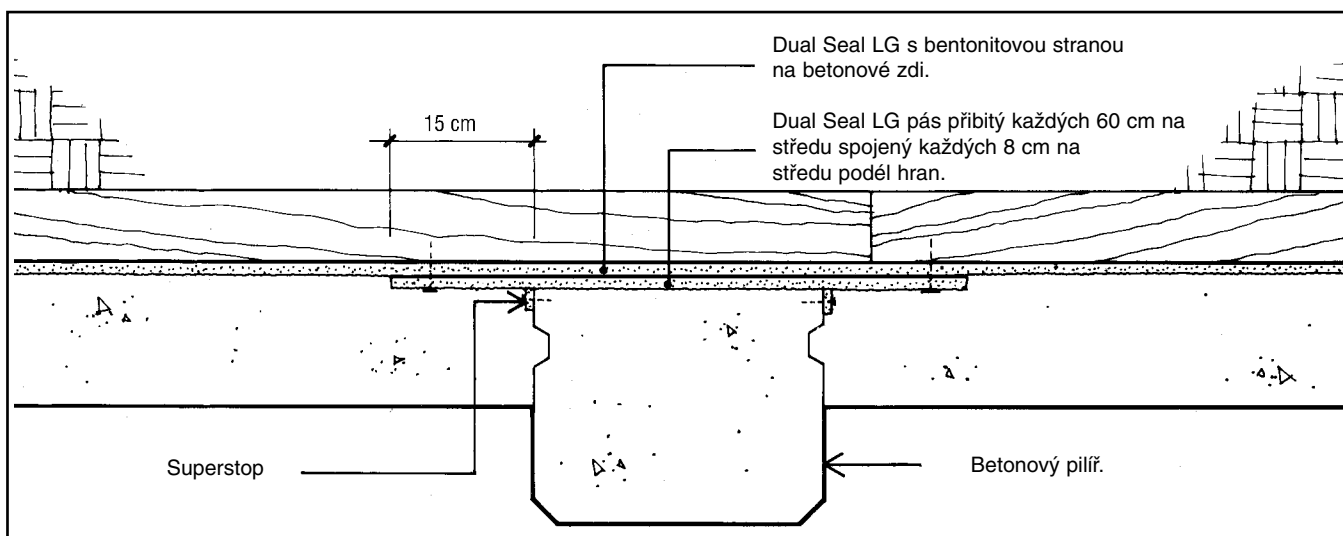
Nechráněné stěny. Krycí lišta nad sklonem.
